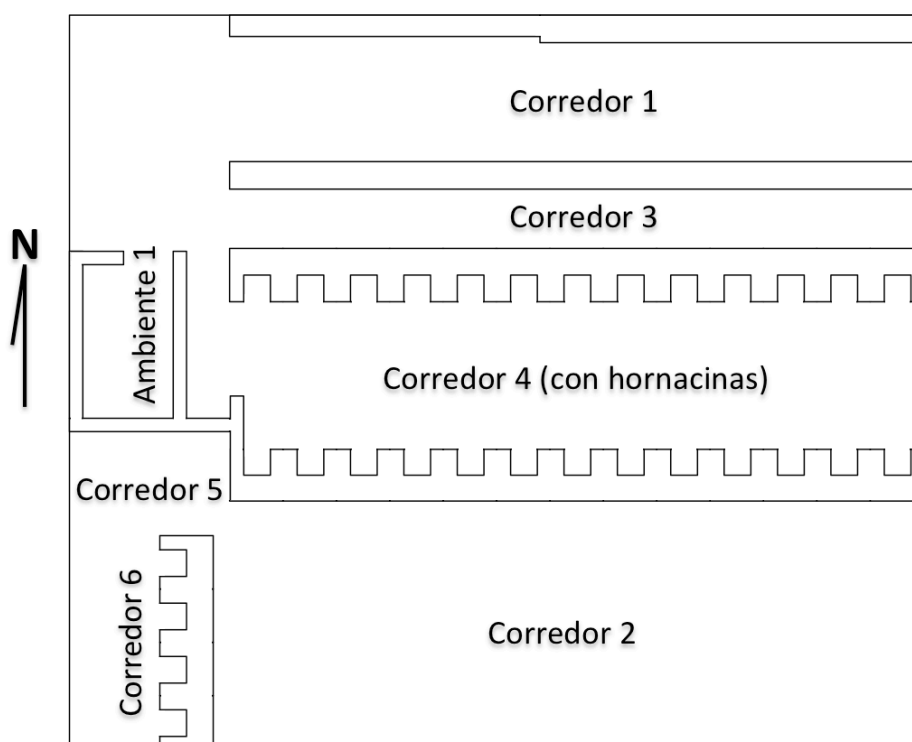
Plano de la fase constructiva 2 de la Plataforma norte (plano del autor).
